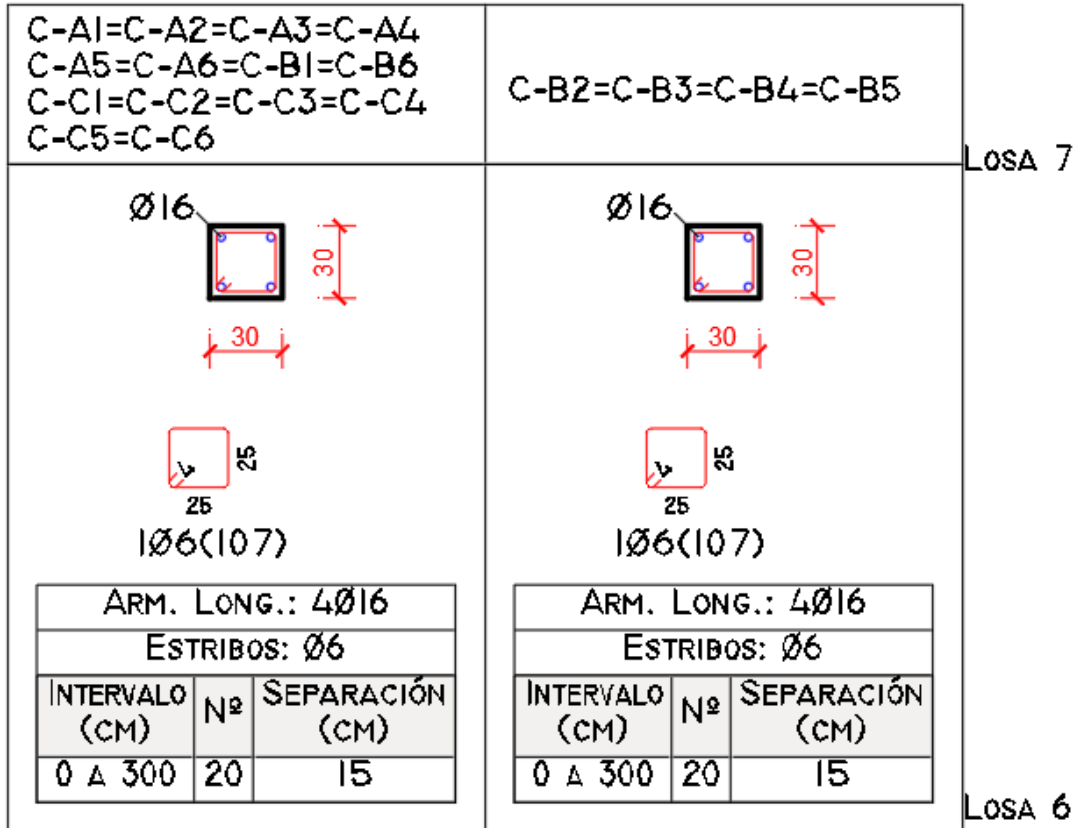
Detalle de Refuerzo Columnas, de Losa 6 a Losa 7, Estructura [7N-SS].
